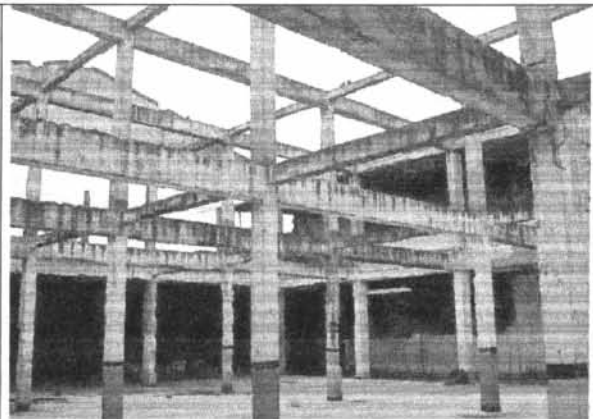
Deterioro interior de la edificación. No hay entrepiso ni cubierta, únicamente el entramado estructural.
